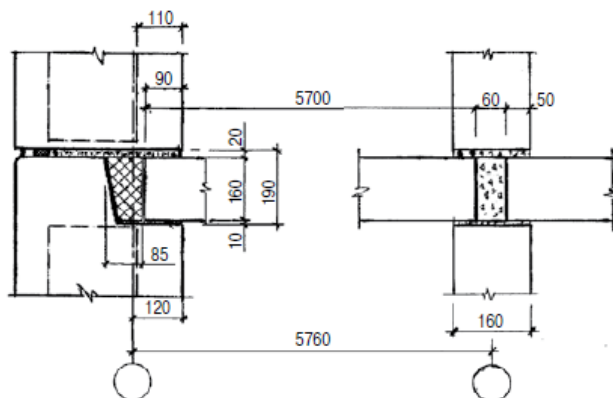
Пример существующей схемы опирания плит перекрытия на продольные стены; ширина площадки опирания на наружные продольные стены-90 мм, на наружные поперечные- 70мм
